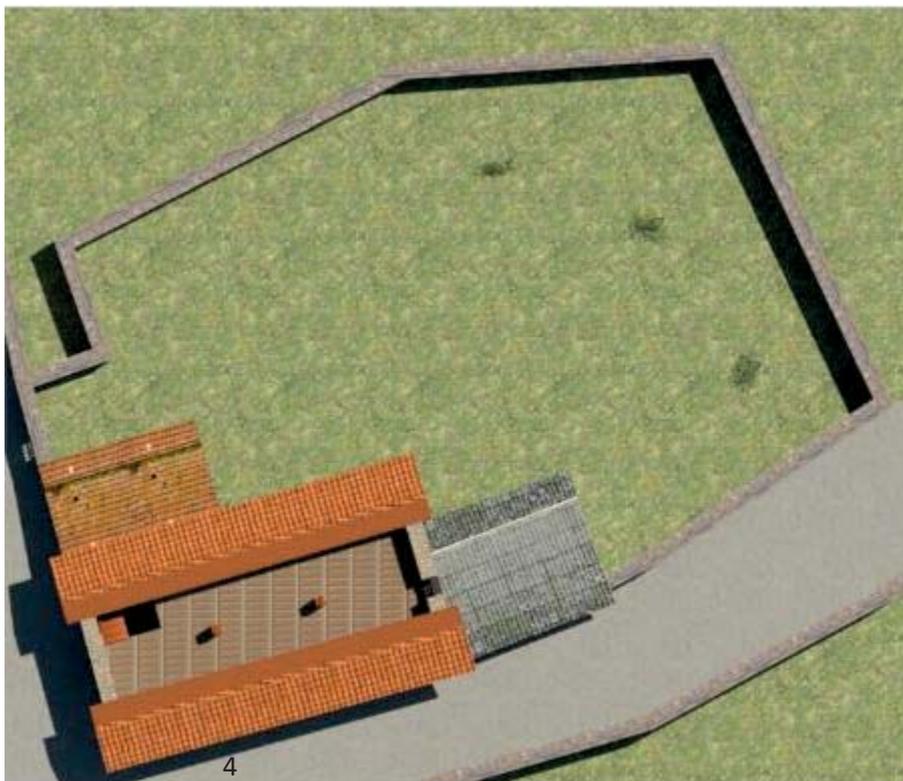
Planta bajocubierta invernadero. Fuente: propia
